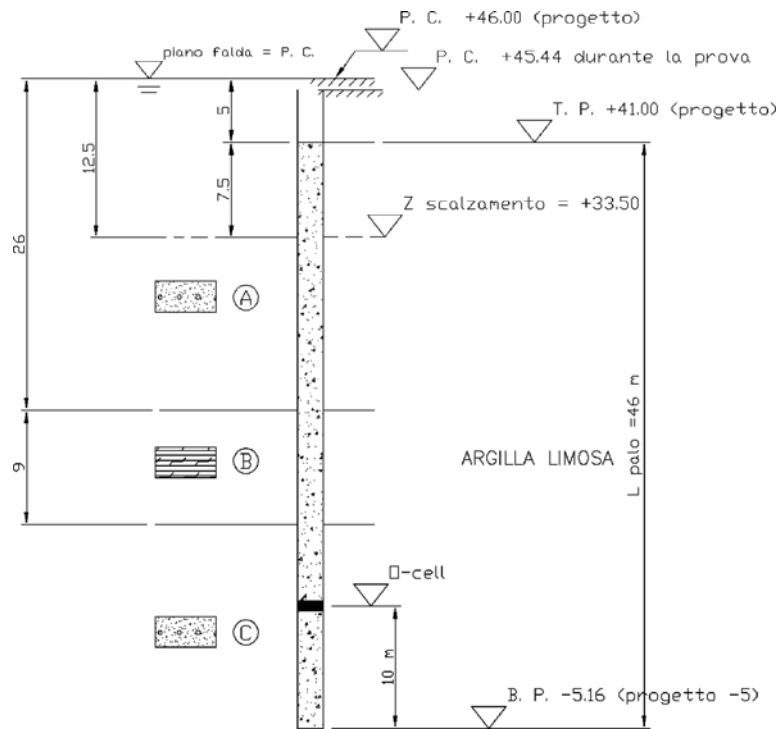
Pilo soggetto a prova di collaudo con cella Osterberg o a prova con zavorra.
